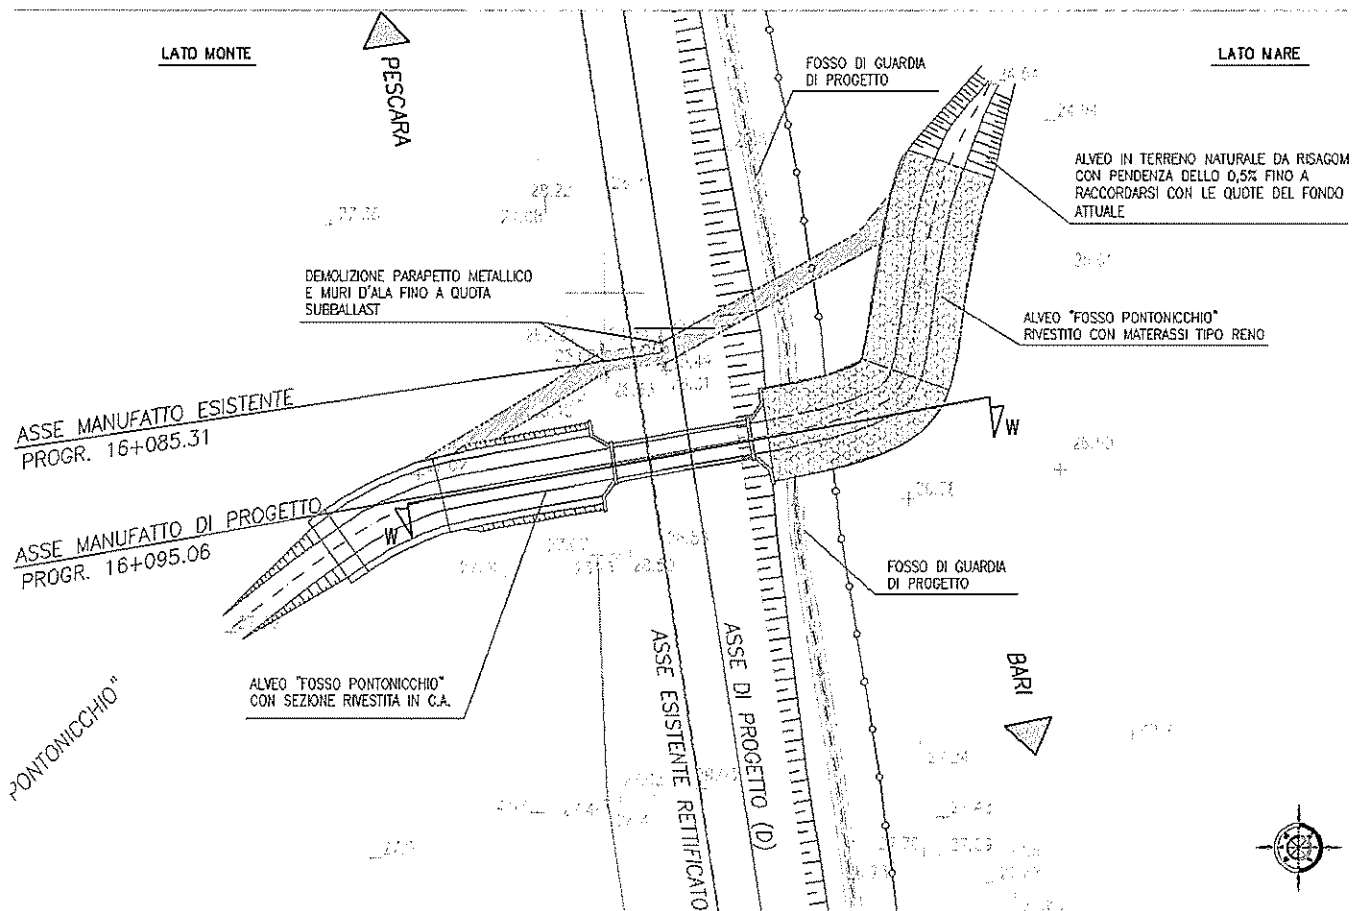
Planimetria del nuovo tombino Canale Pontonichio
